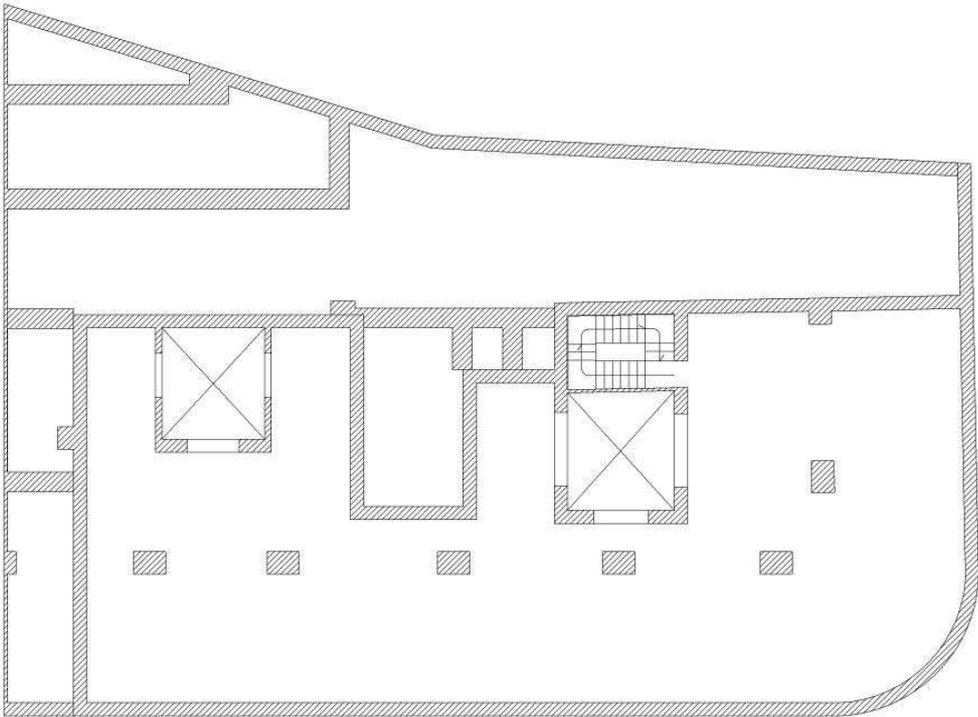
Levantamiento CAD Planta sótano Edificio Niederleytner. Fuente: Elaboración propia.
